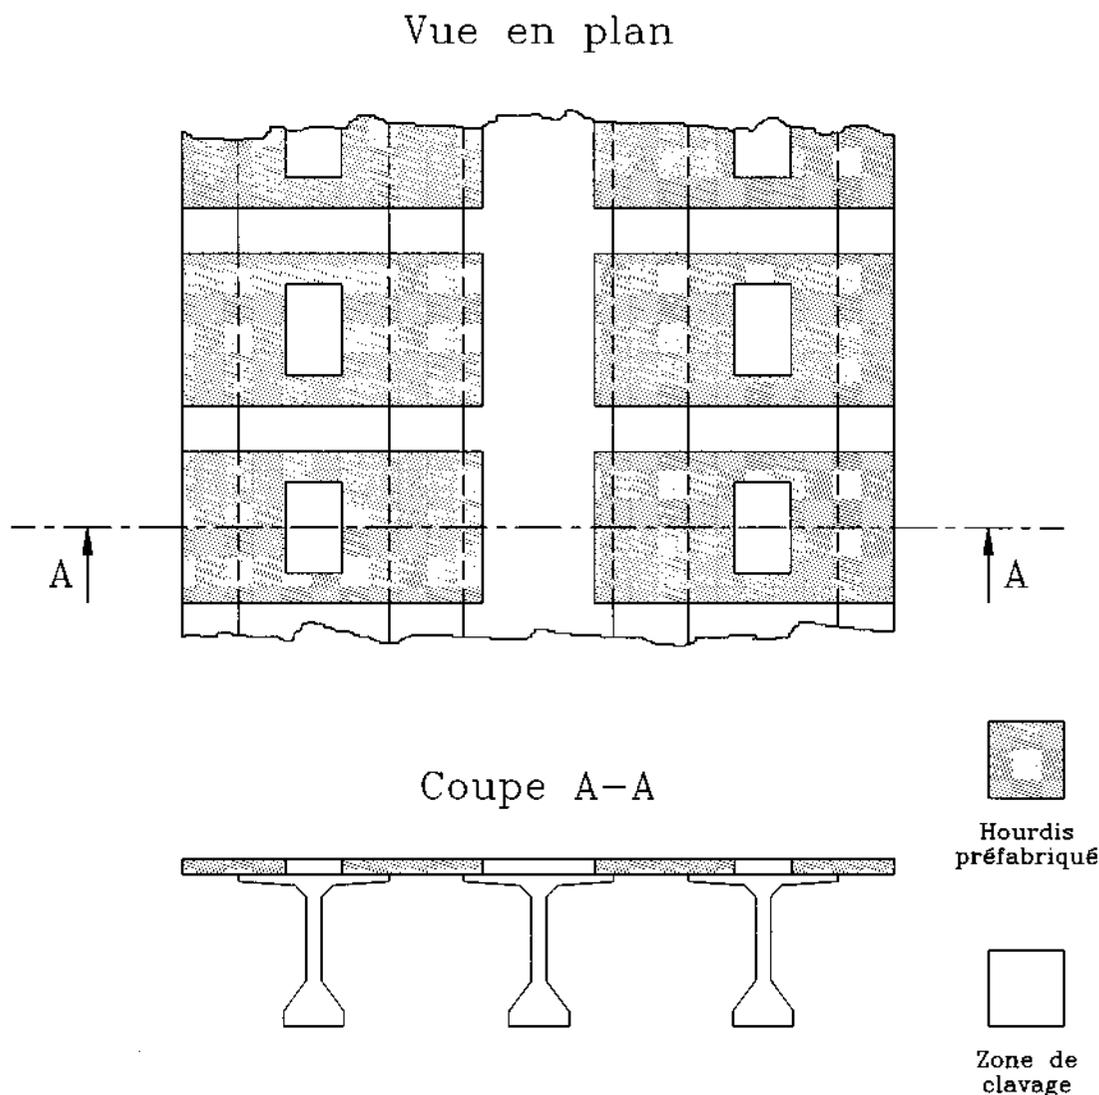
Hourdis préfabriqué en pleine épaisseur
